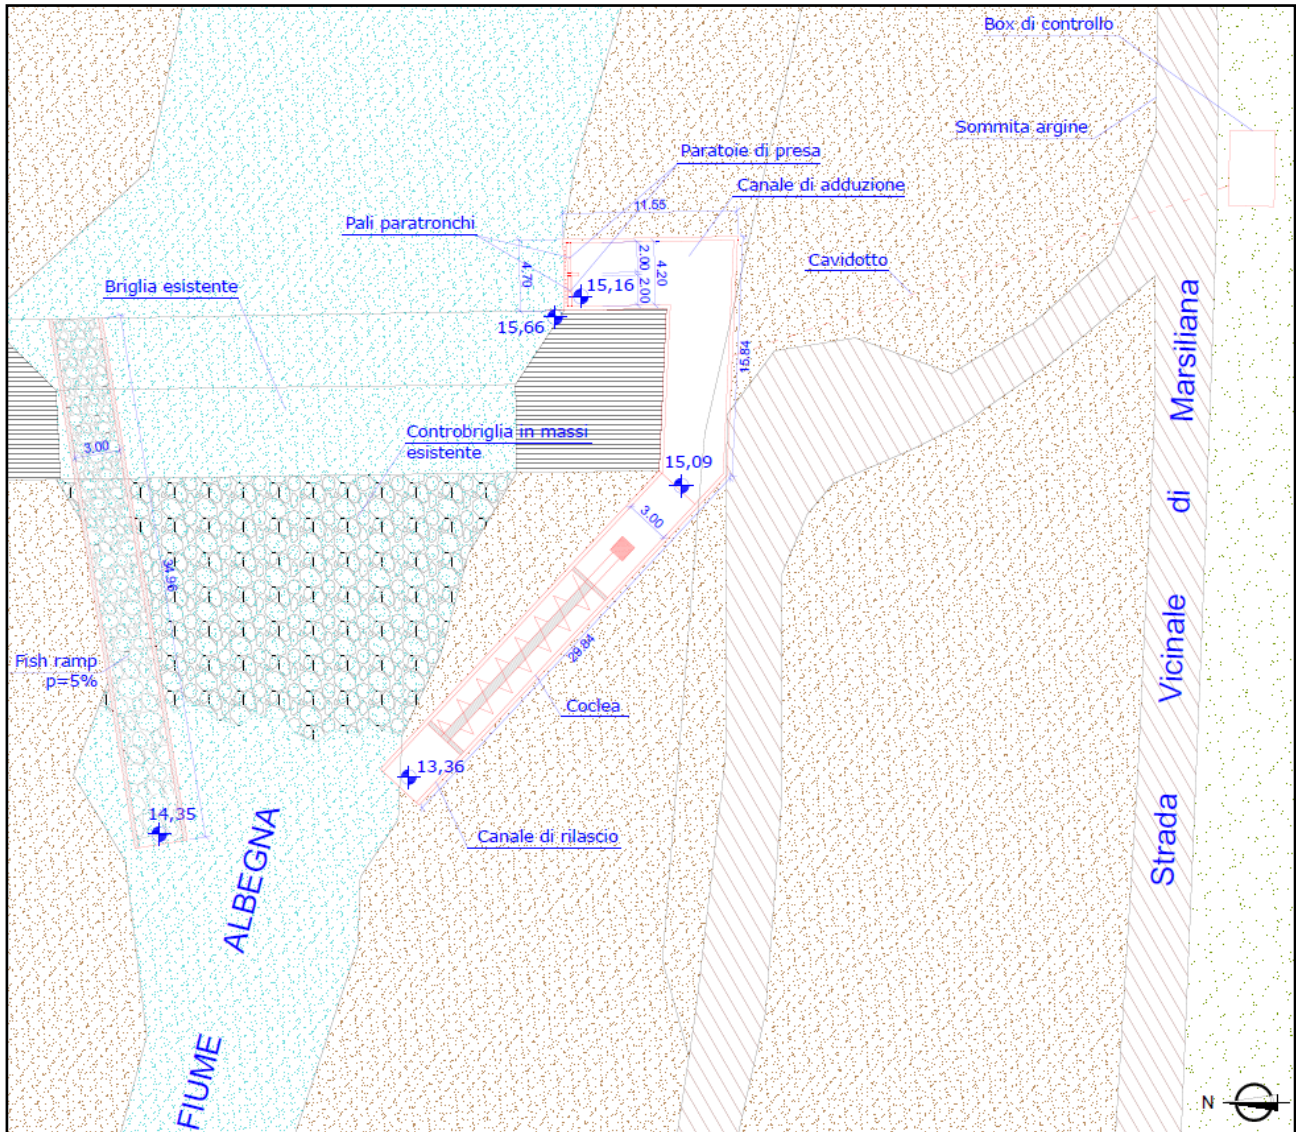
Sezione planimetrica Progetto centrale idroelettrica "Marsiliana".
